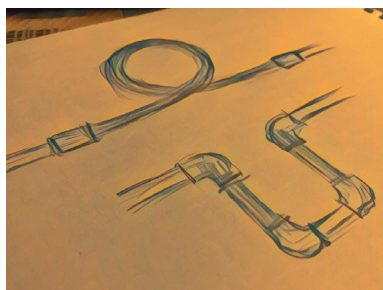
О-образный и П-образный компенсаторы (фото автора портала «Штуки из труб»)
